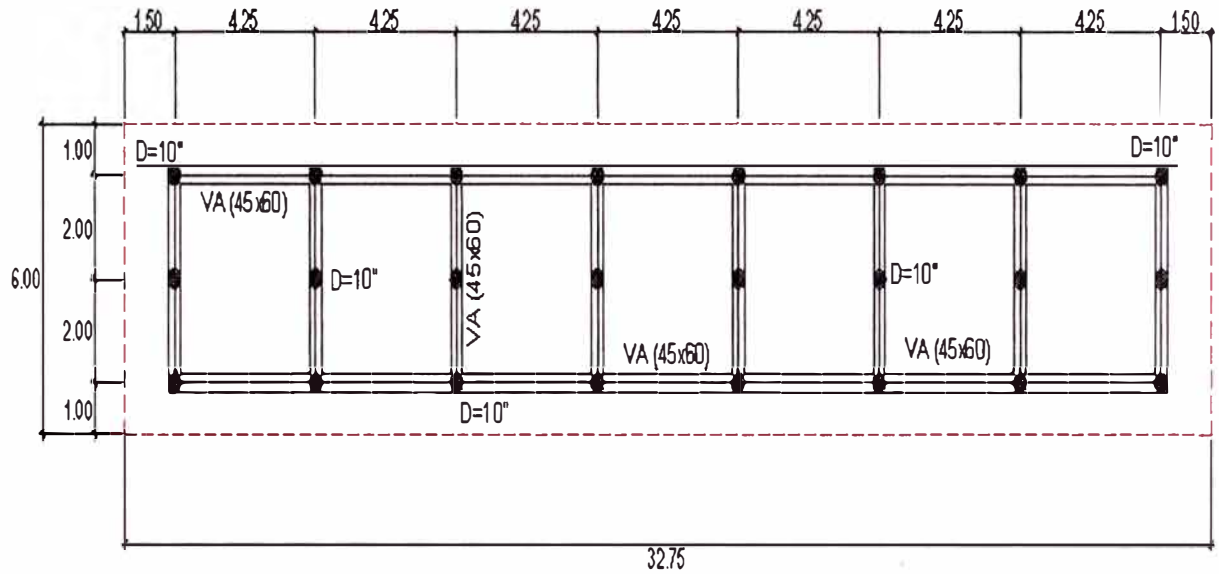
Distribución de pilotes y vigas de arrioste en el 2do tramo
